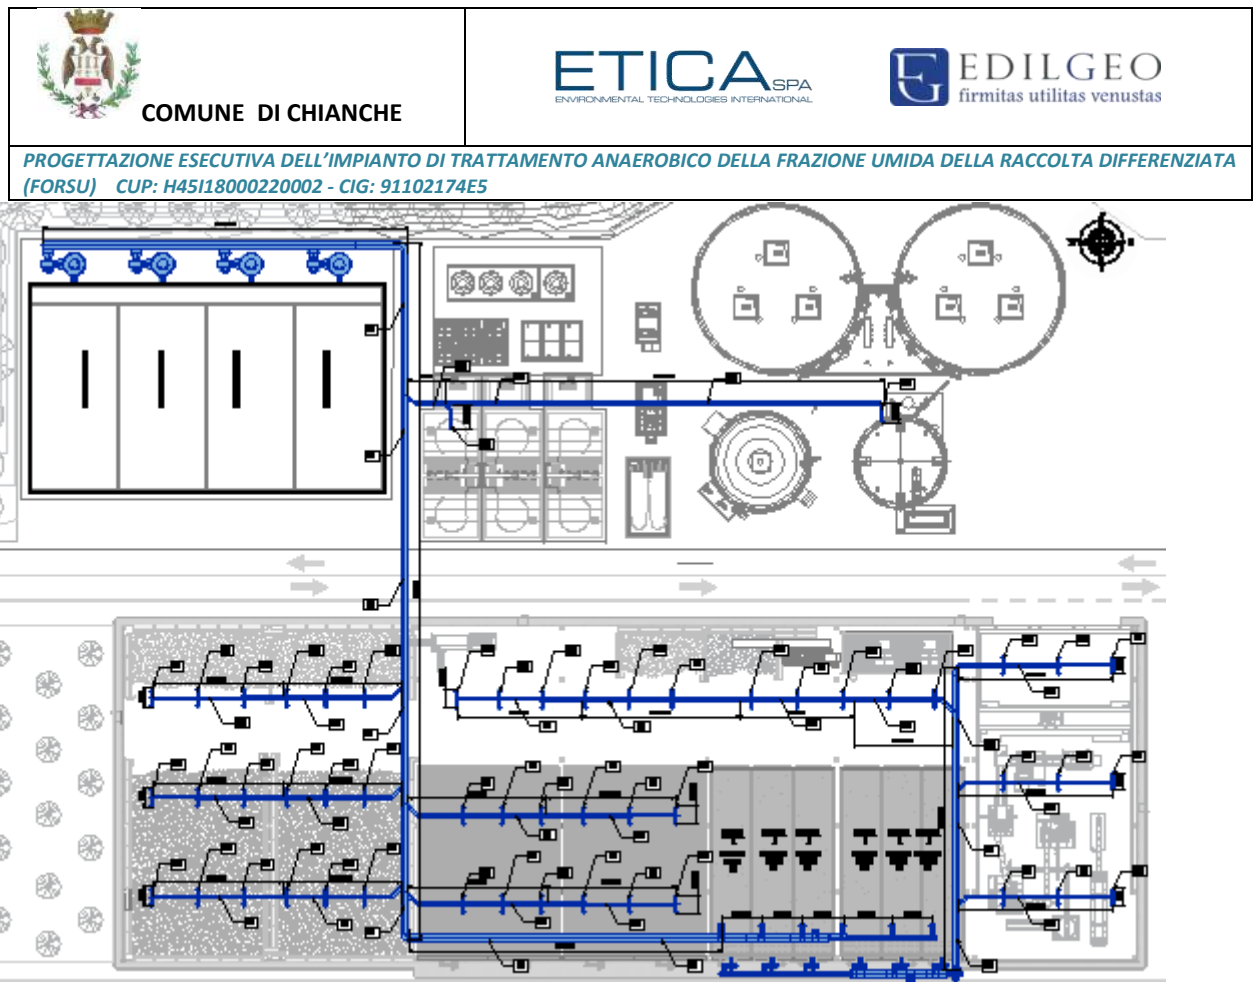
Planimetria rete aspirazione e ricircolo aria
